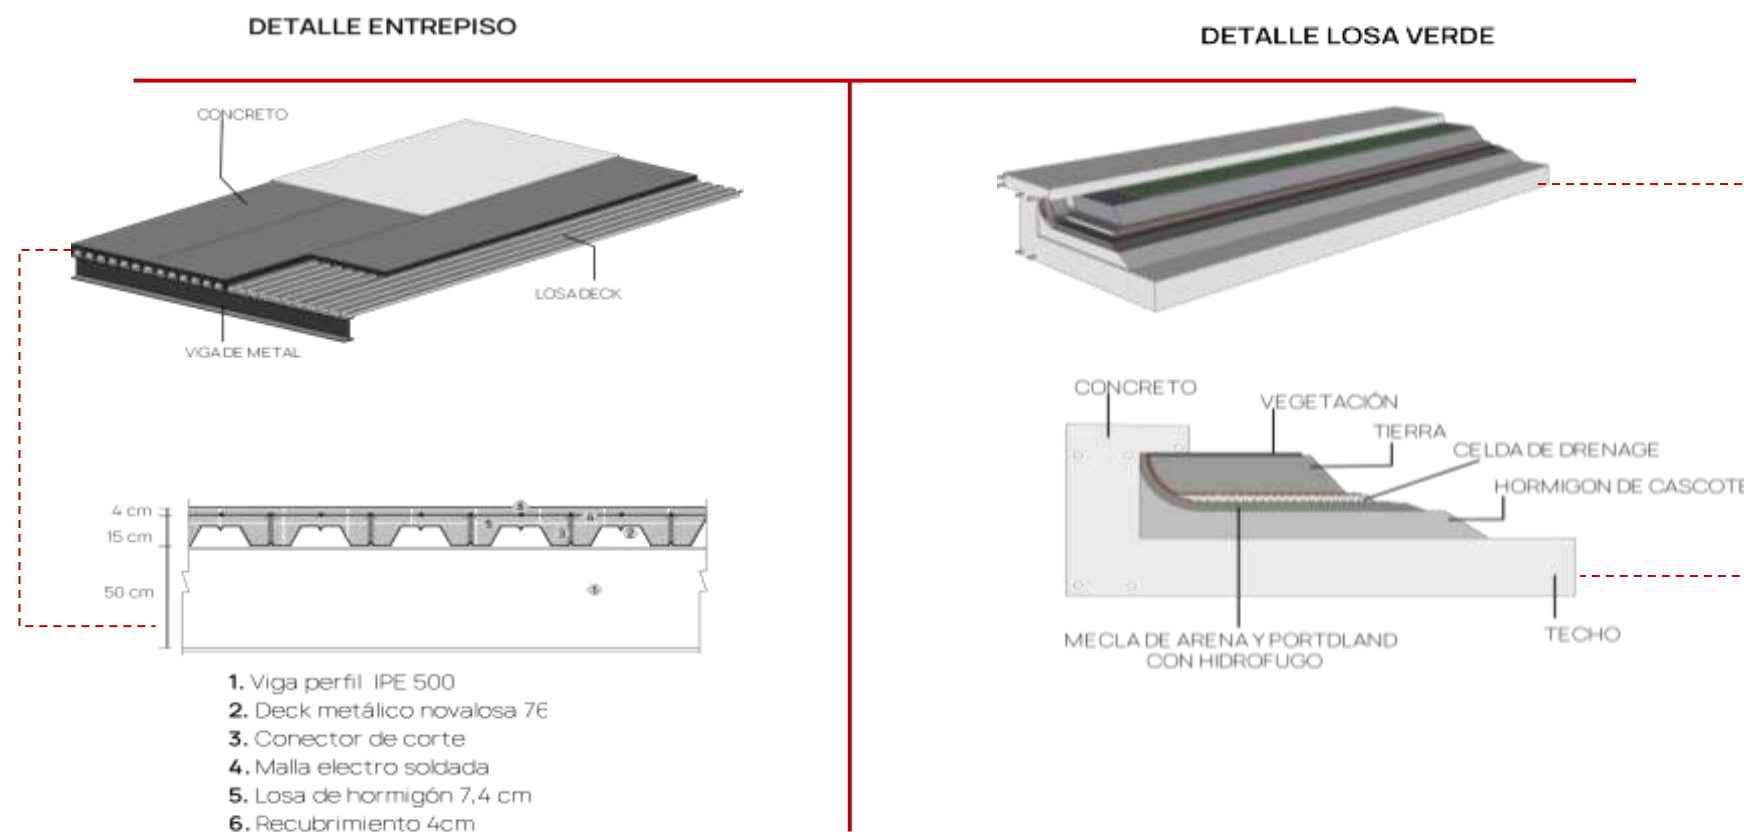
Detalles estructurales Elaboración: Propia Fuente: Propia
